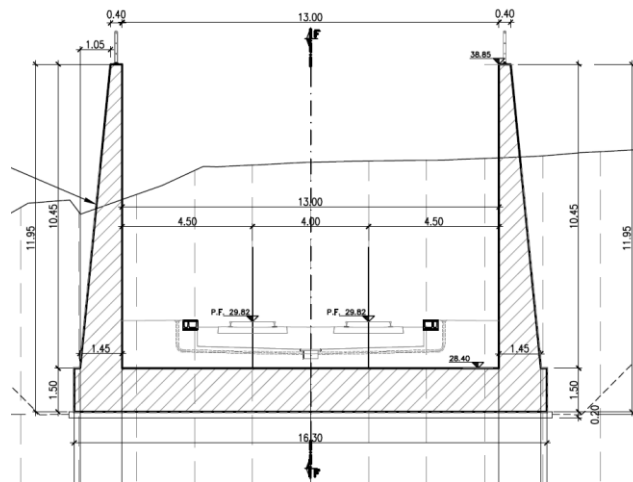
Sezione muro di imbocco (Hmax=10.55 m)
